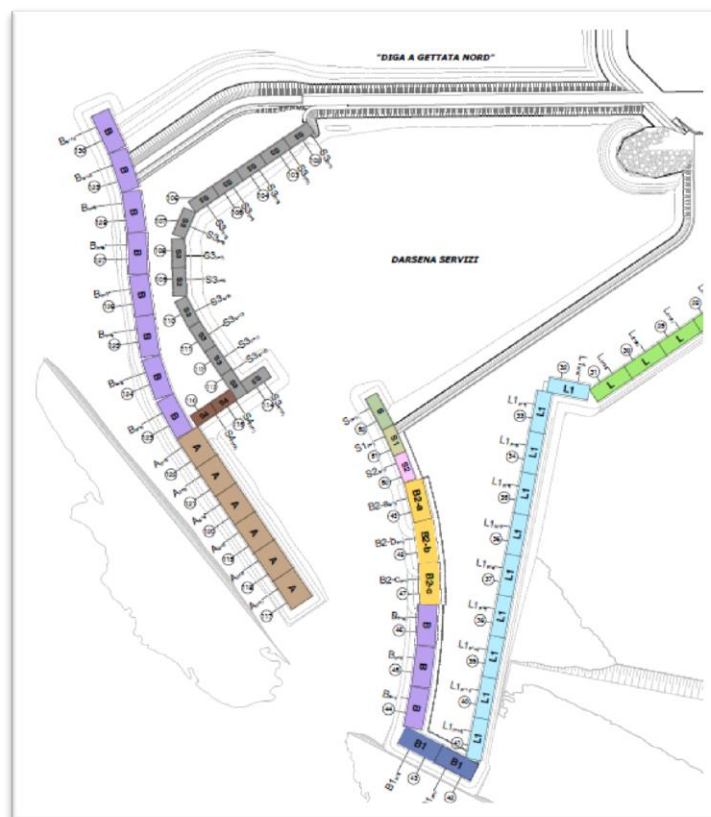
Stralcio planimetria classificazione cassoni Perizia di Variante N°2
